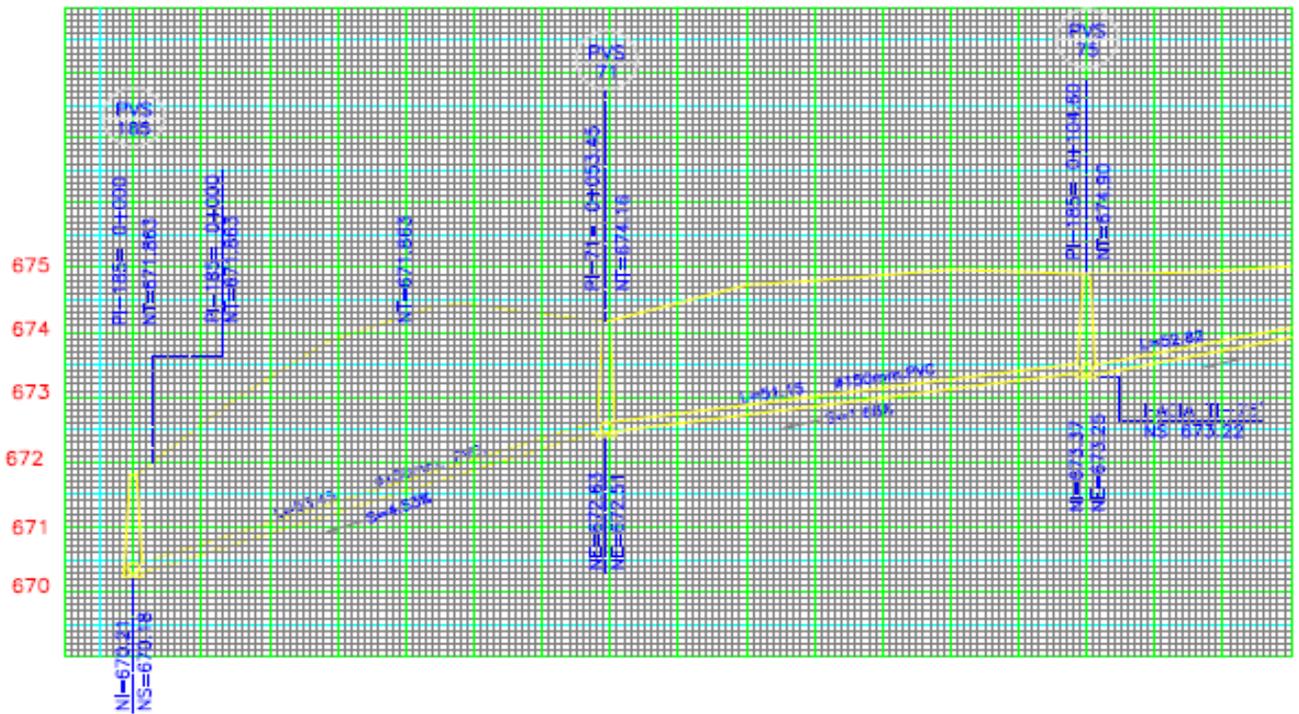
Plano de Planta típica de un sistema de alcantarillado sanitario
